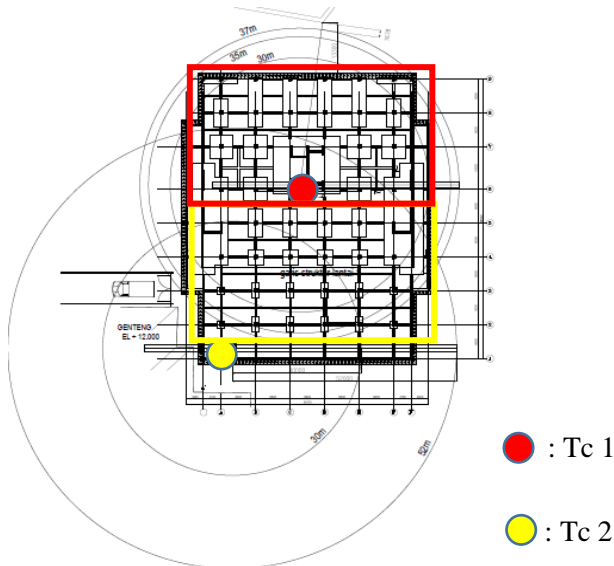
Denah *Tower Crane* dan *Stockyard
